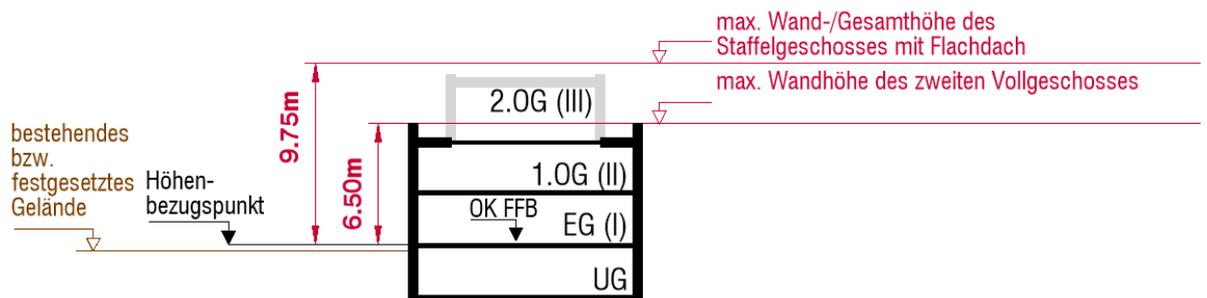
Beispielhafte Systemskizze für ein zurückversetztes Staffelgeschoss mit Flachdach im WA 2, o. M.
